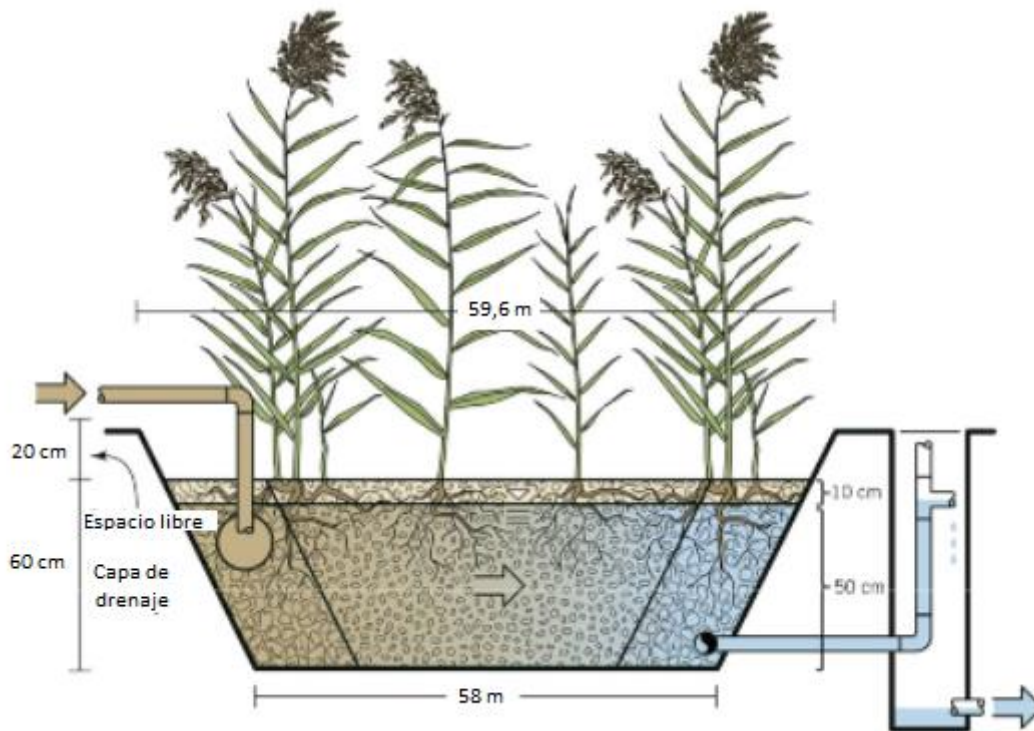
Imagen que muestra las cotas y detalles del humedal calculado sección A-A' (no a escala). Fuente: IWA
